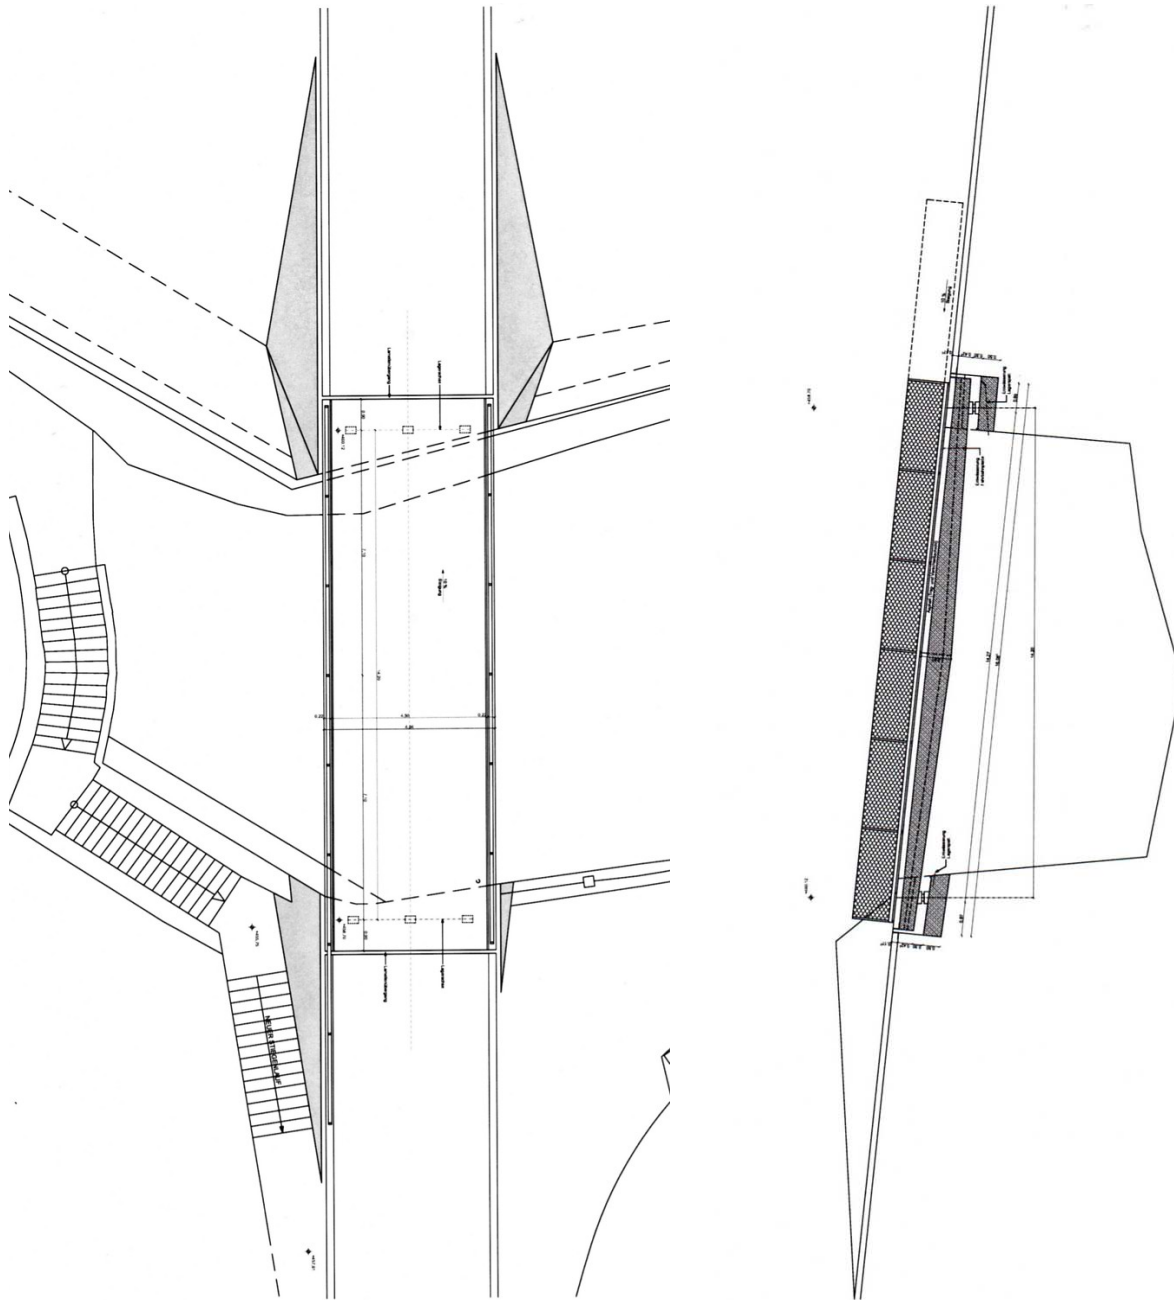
Entwurf der Brücke an der Monikapforte, Grundriss und Längsansicht
